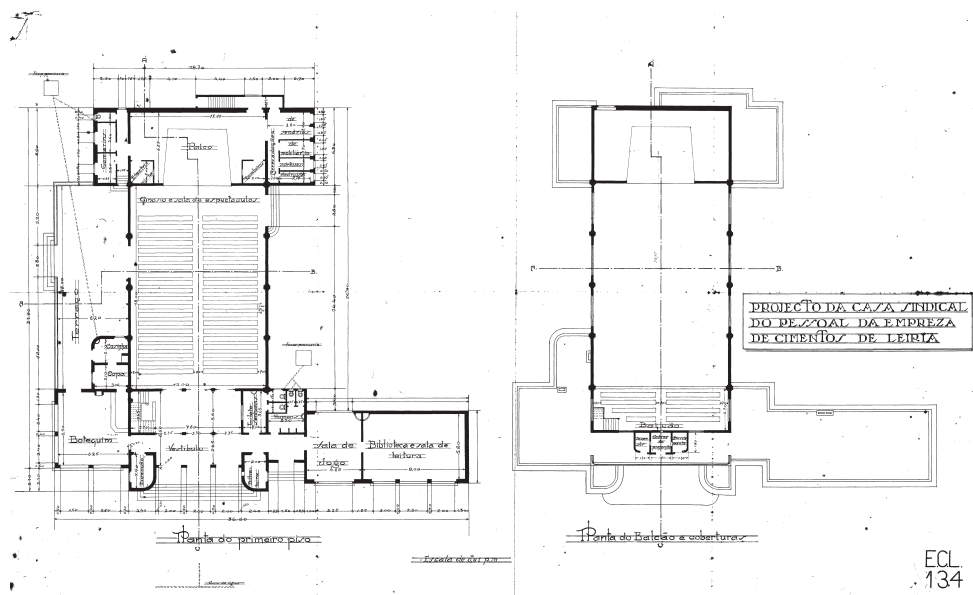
Planta 1º e 2º piso da Casa do Pessoal, s.d
